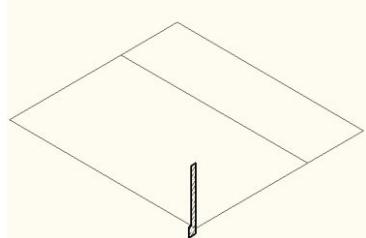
Аксонометрична проекція базису для формування корпусу споруди
